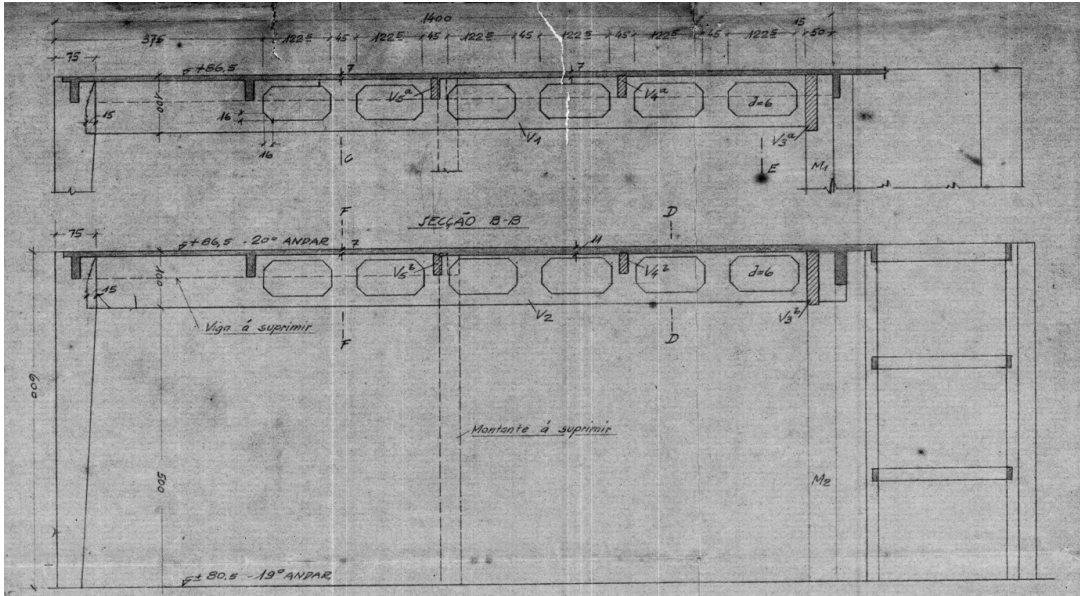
Detalhe da Viga do 19º pavimento e armação da viga. Acervo da SEECLA. FONTE: SEECLA, 2014.
